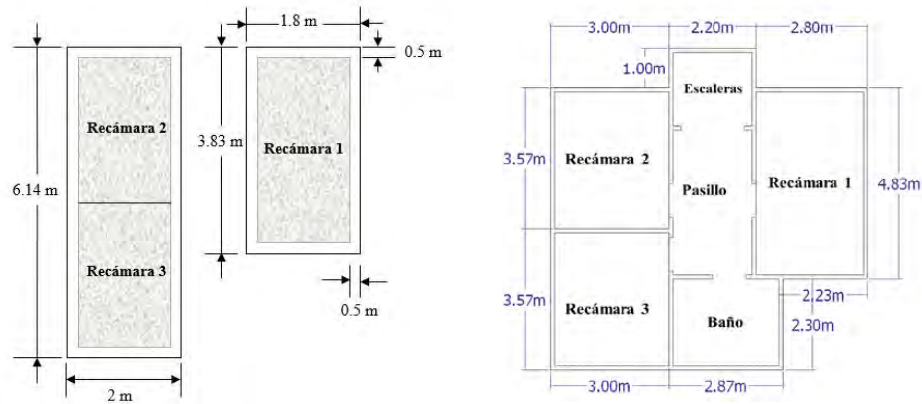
Planos de la modificaciones para las configuraciones de techo.
